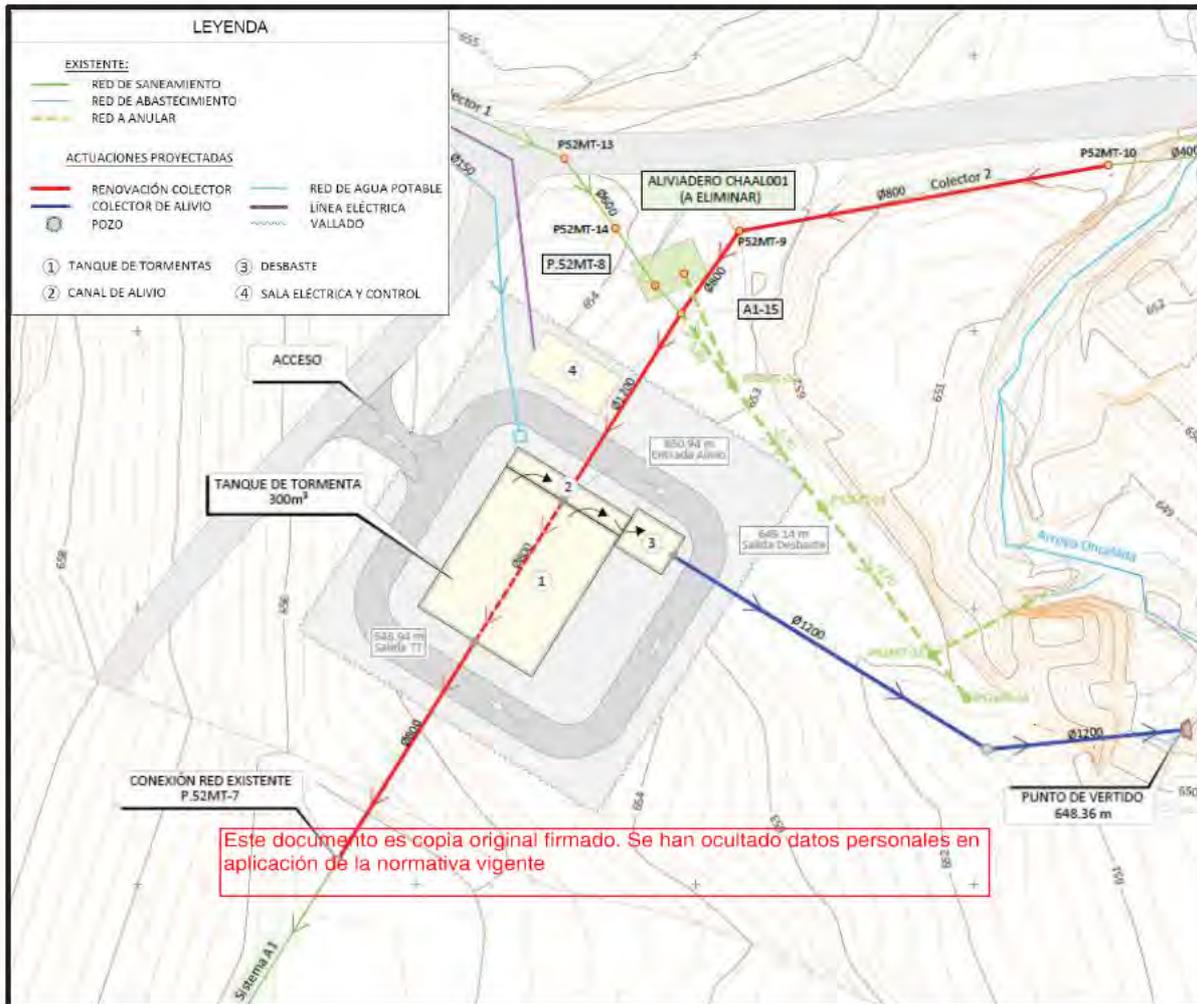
Planta general de la actuación. Fuente: plano nº 2 de la documentación presentada.
